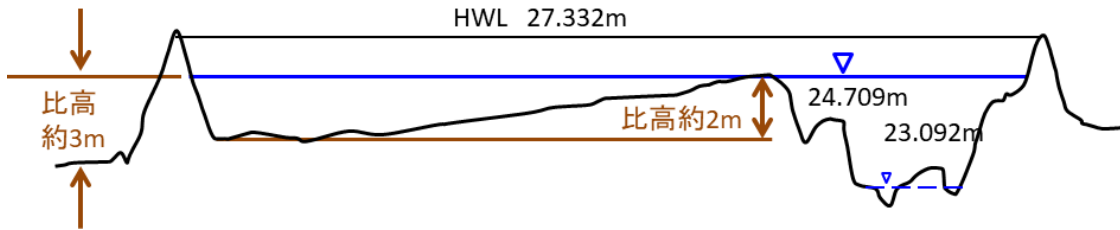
都幾川上流未改修区間断面図 河道内に自然堤防発達
